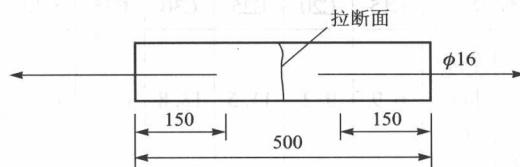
混凝土直接受拉实验（尺寸单位：mm）
